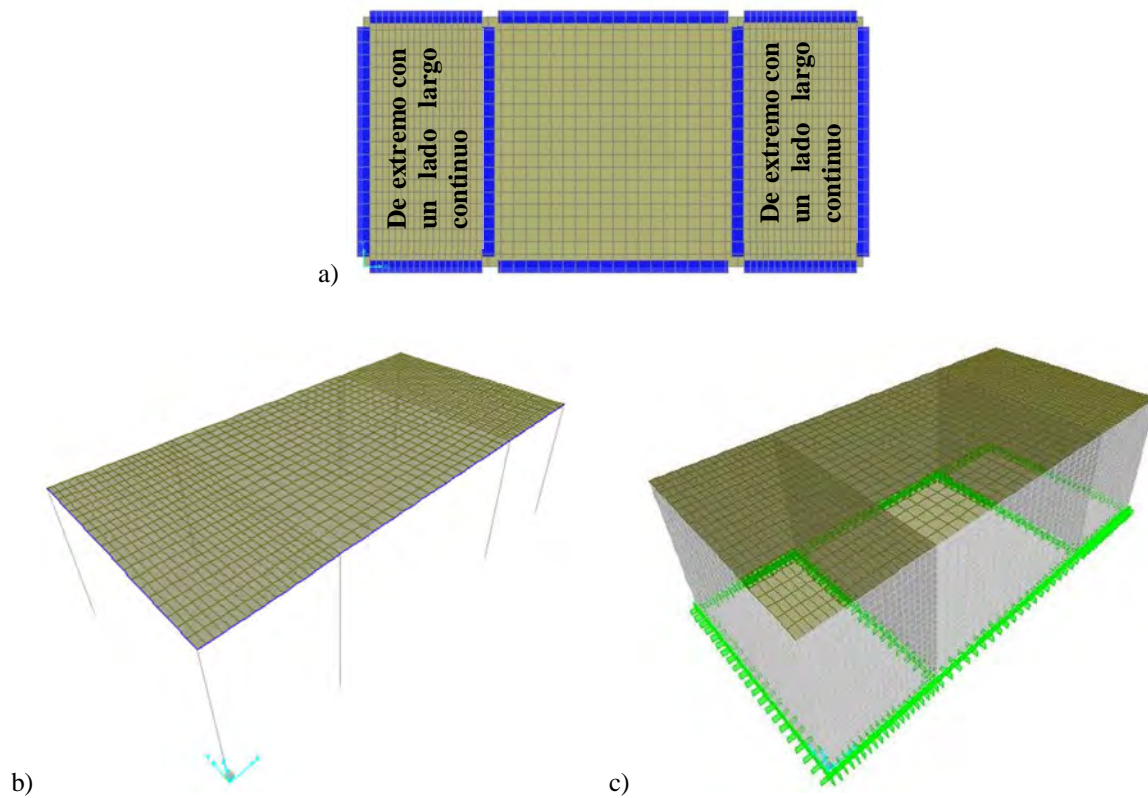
Paneles de extremo con un lado largo discontinuo: a) planta, b) apoyados sobre vigas y c) sobre muros.
